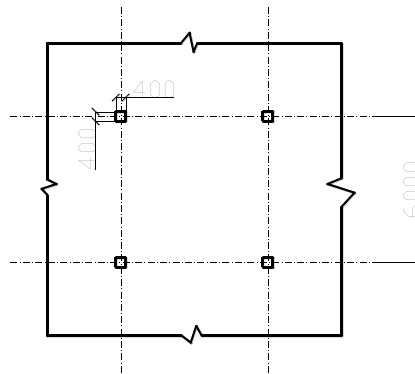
Схема безбалочного перекрытия по методу предельного равновесия
